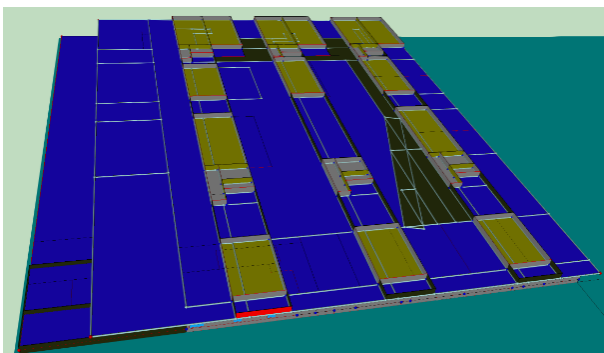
LIDER. Modelado Entreplanta y Cubiertas Planta Baja
